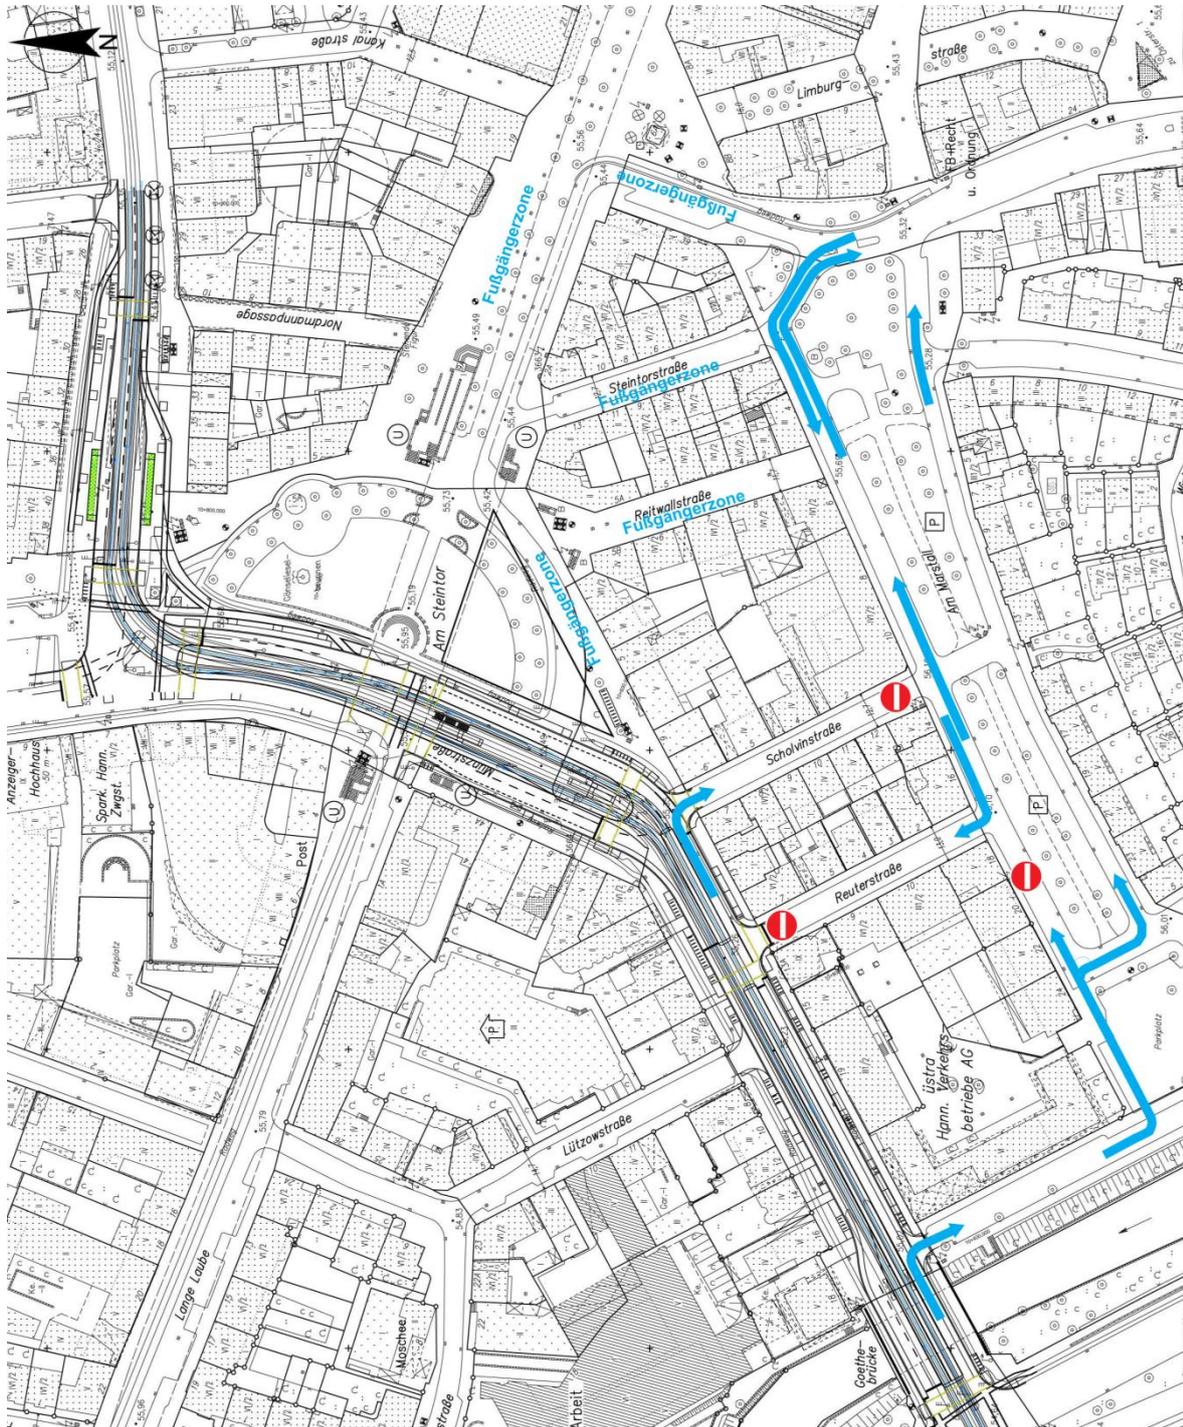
geplante Verkehrsführung Am Marstall/Schmiedestraße/Steintor
